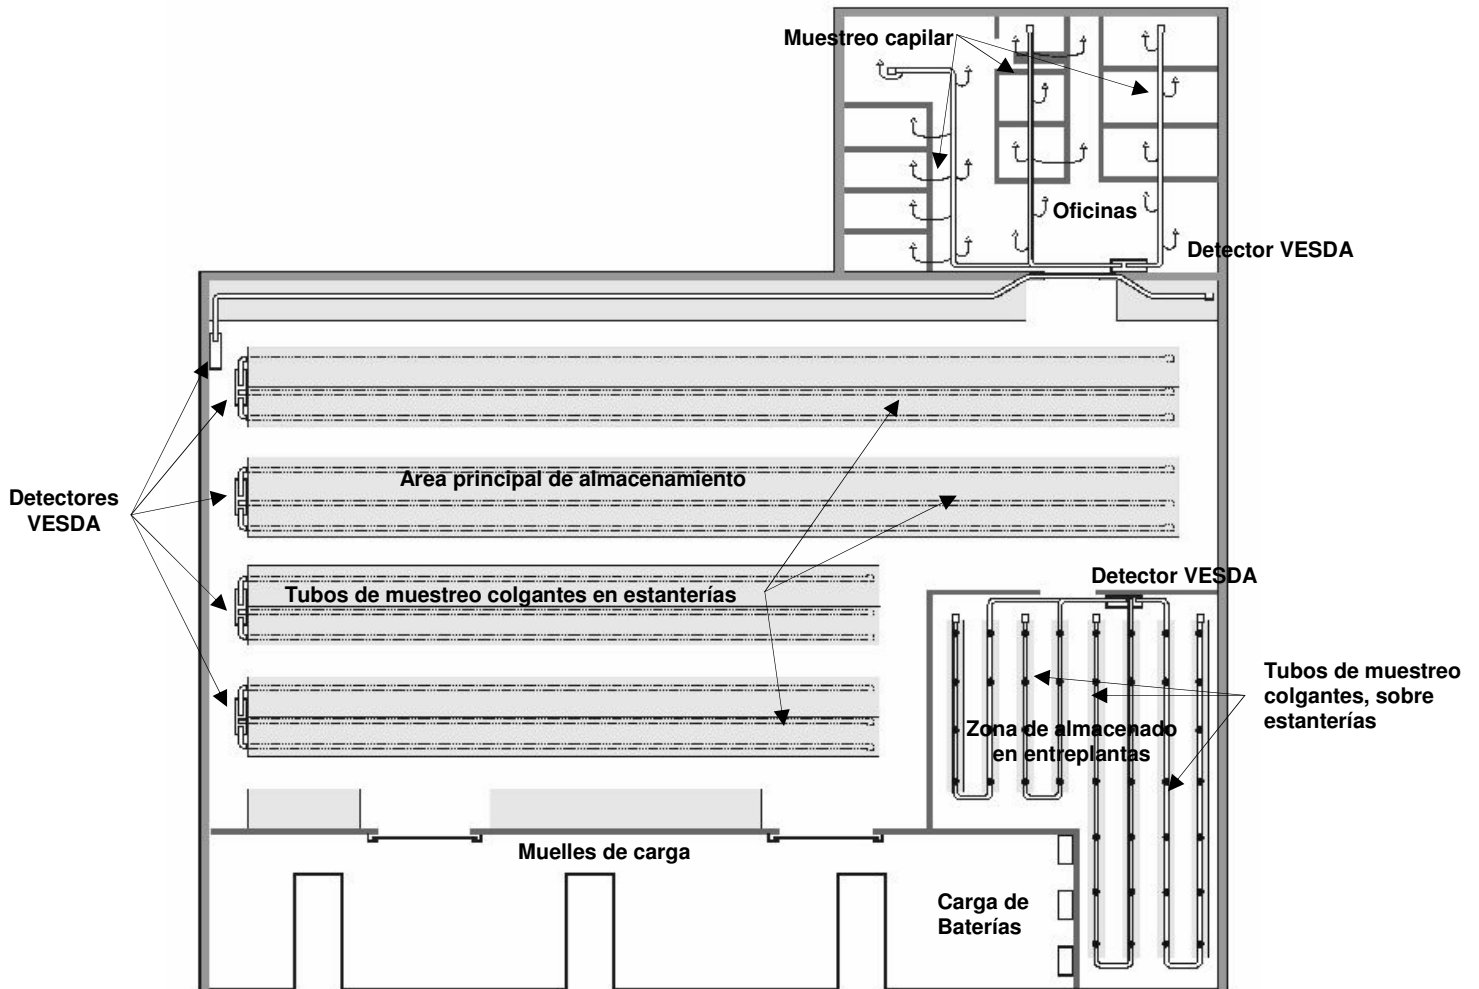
Planta de un almacén – Configuración de la protección en estanterías, sobre estanterías y mediante tubos capilares
